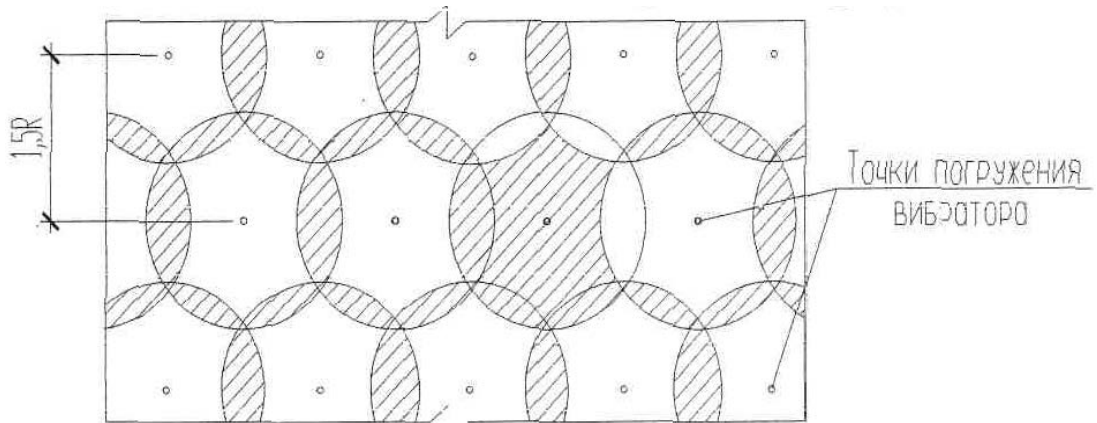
Схема розташування точок занурення робочої частини вібратора
